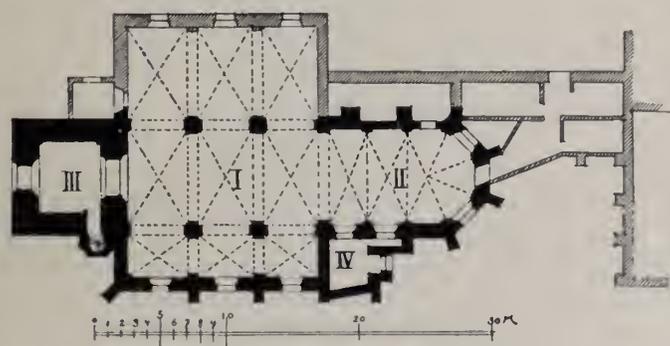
Kaldenkirchen. Grundriss der kath. Pfarrkirche.
